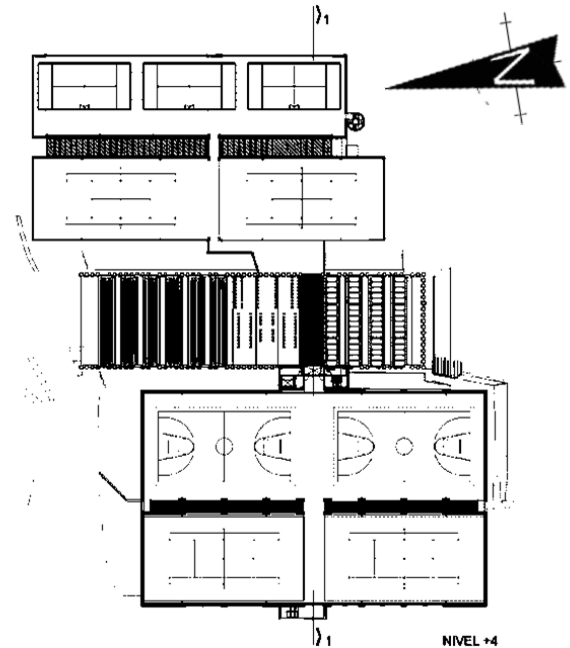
Planta Arquitectónica, nivel 2
